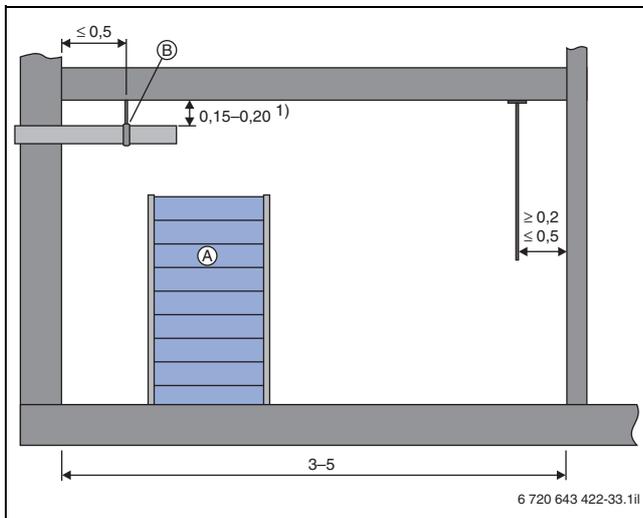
Schnitt durch ein Pelletlager mit Raumlänge 3 m bis 5 m (Maße in m)
